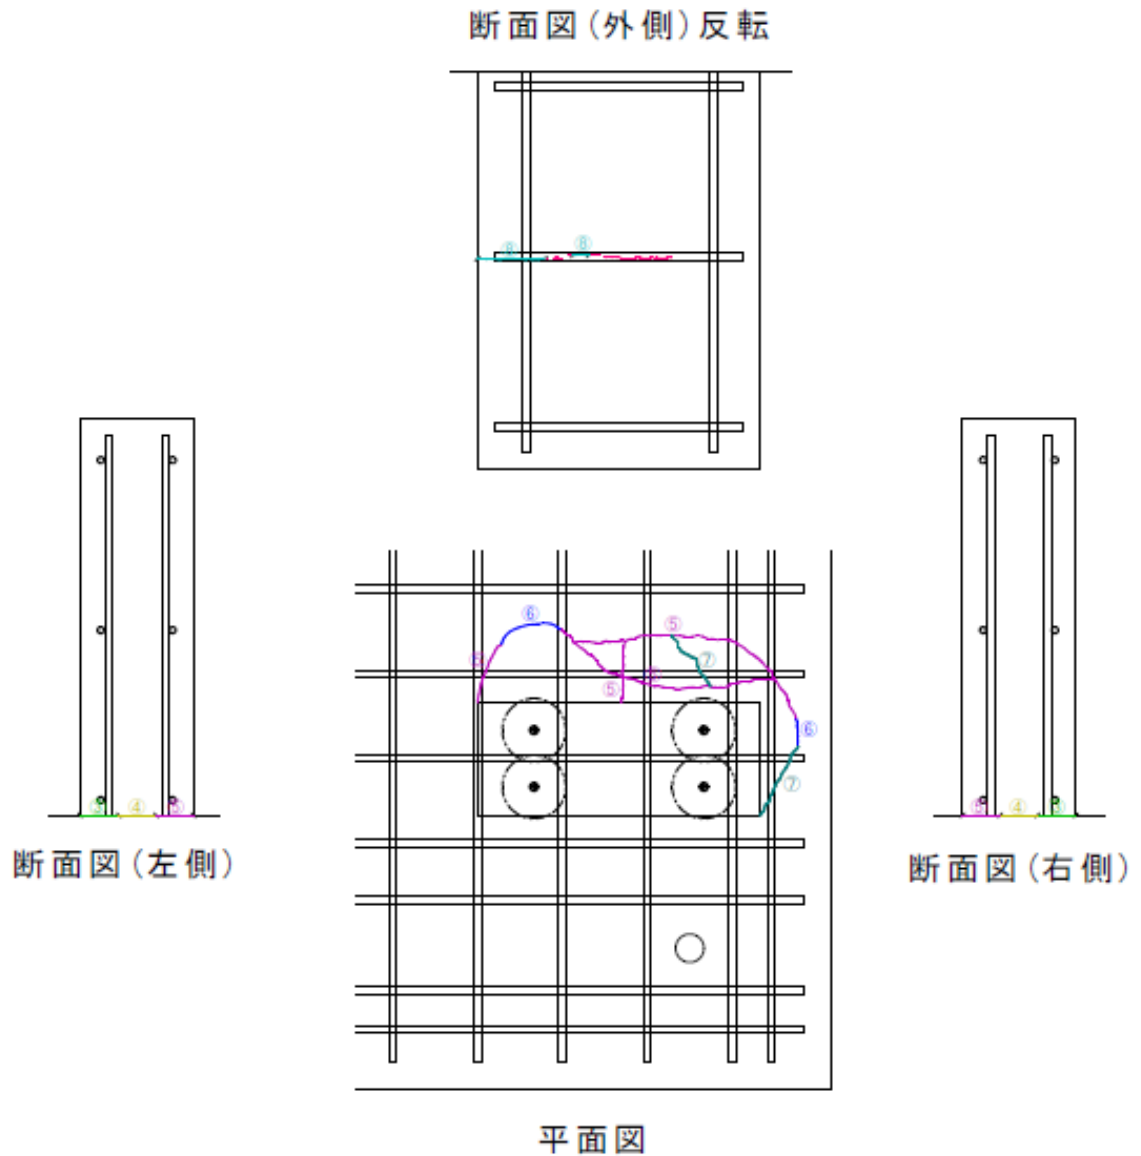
ひび割れ図および最終破壊状況写真 (No.6R)
